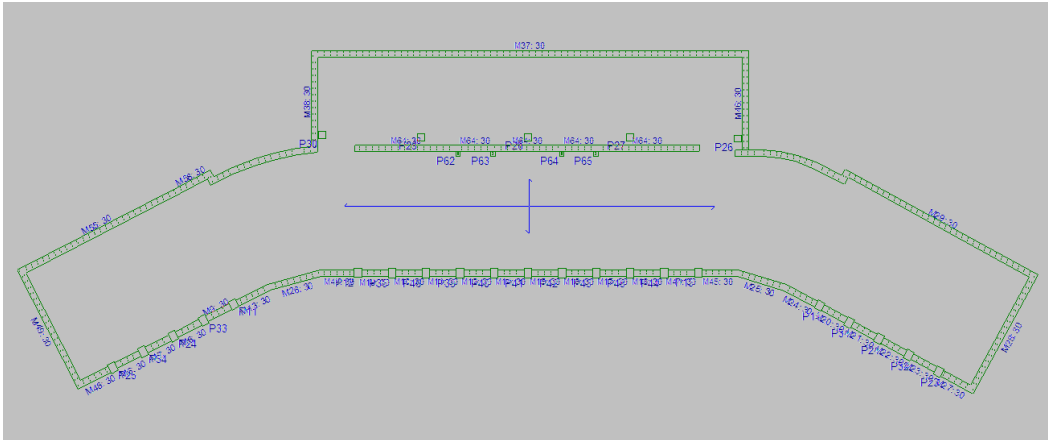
Planta cubierta del modelo real idealizado
